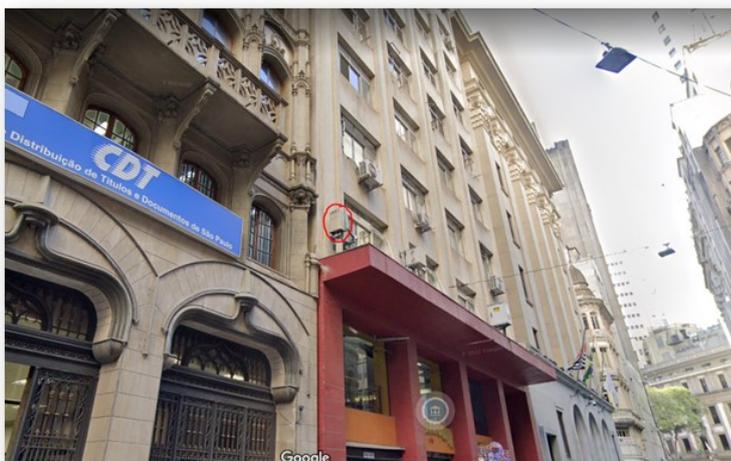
Equipamentos instalados em fachadas ou marquises
